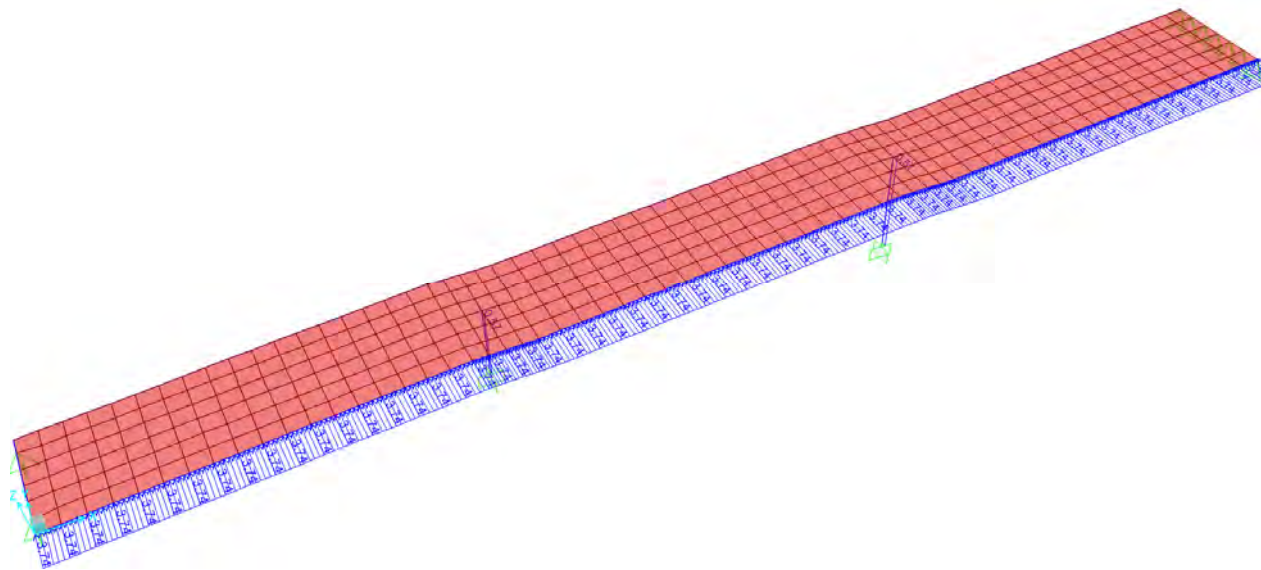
Carga (fuerza) de viento con sobrecarga en tablero y pilas (*VIENTO\_SC*)
